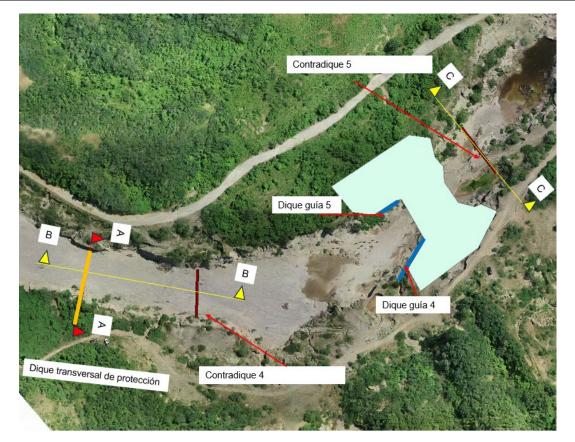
Vista en Planta de las obras de protección propuestas para el dique transversal 02
